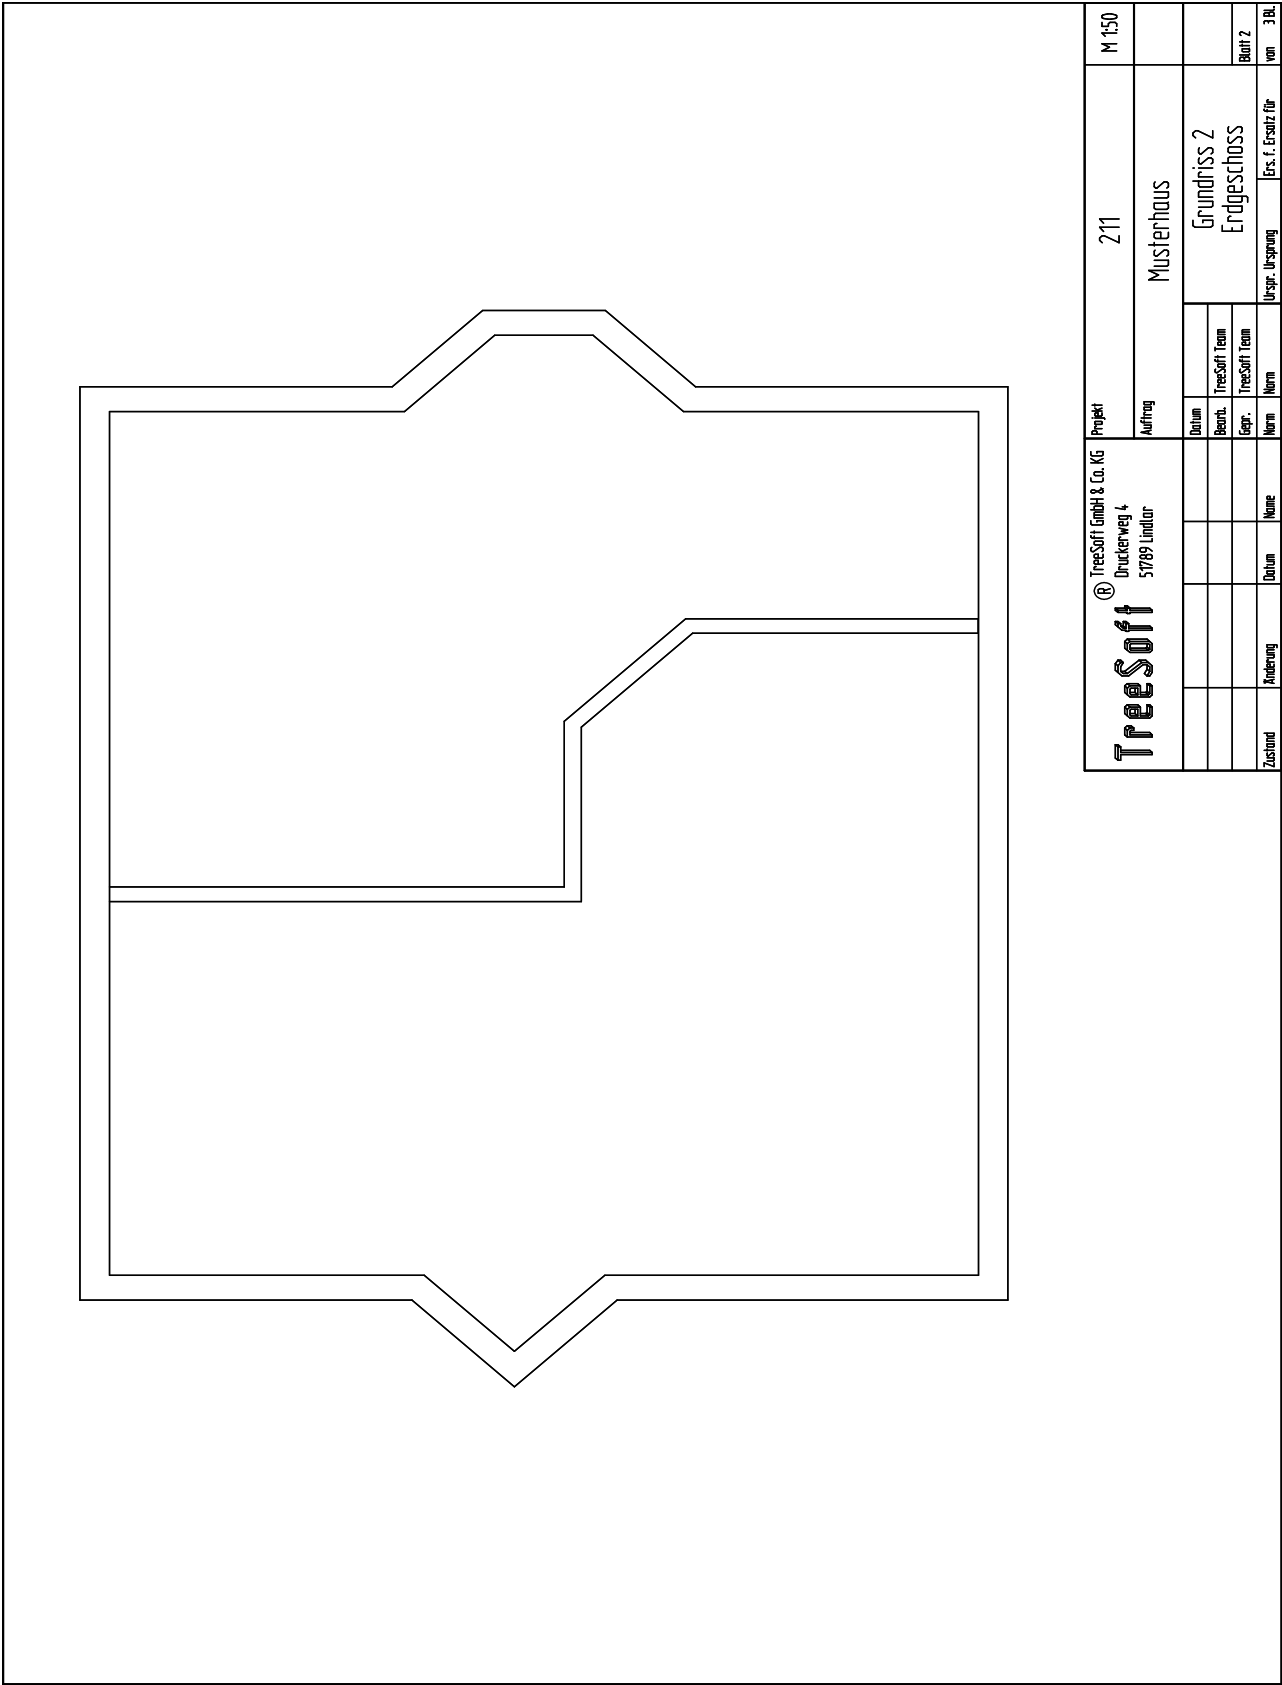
Grundriss mit tragender Innenwand
